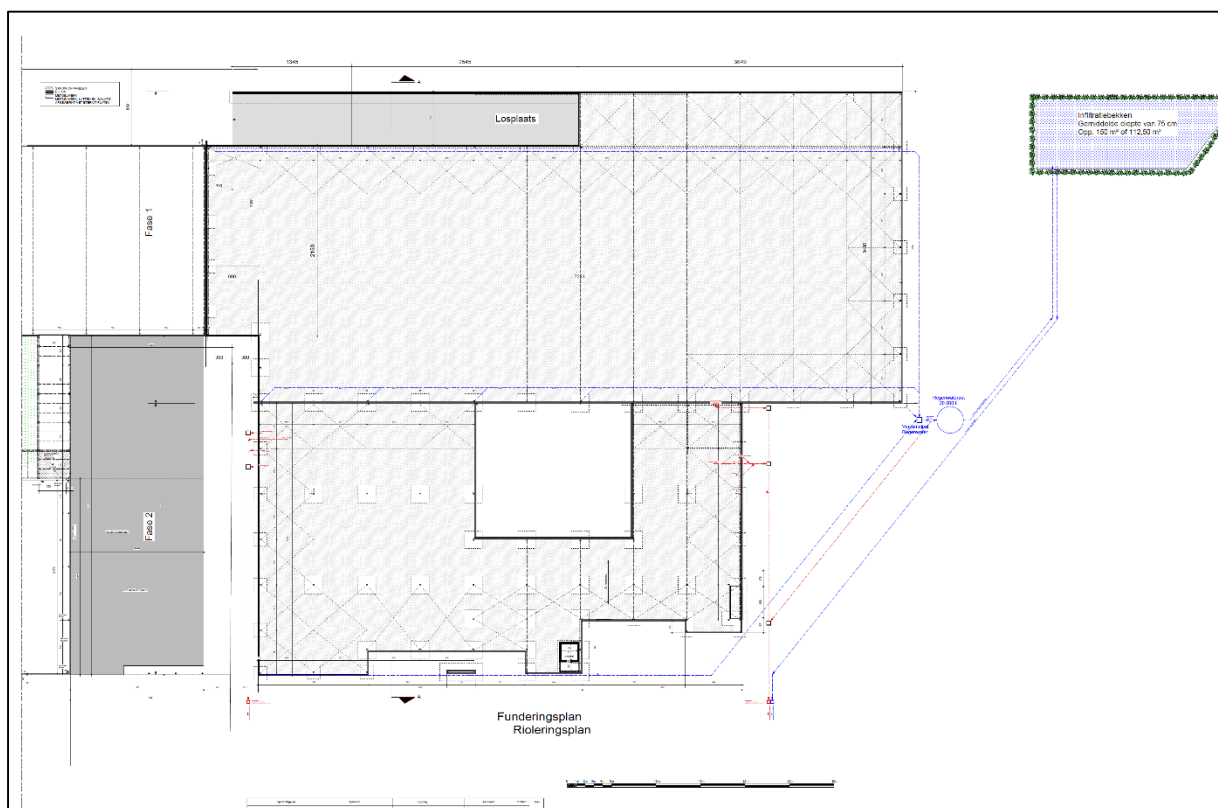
funderingsplan zoals aangereikt door het architectenbureau
